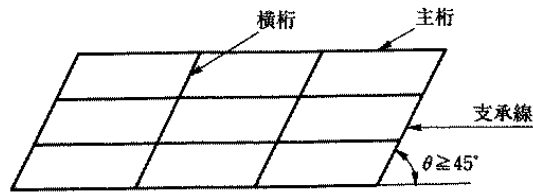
斜角 45° 以上の場合の横桁の配置列
